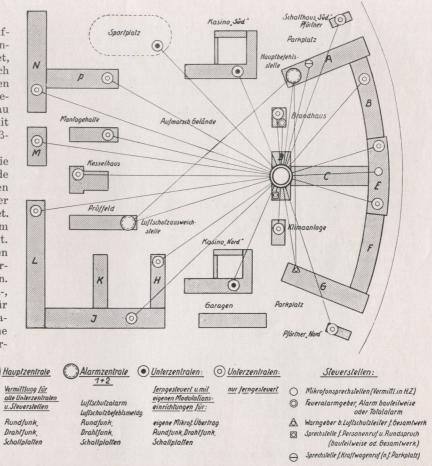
Gebäudeplan und örtlicher Aufbau der Betriebs-Lautsprecheranlage eines Großbetriebes,
